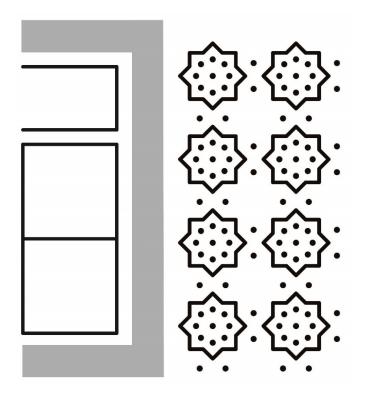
Pormenor da fachada de uma casa na Rua do Azulejo
